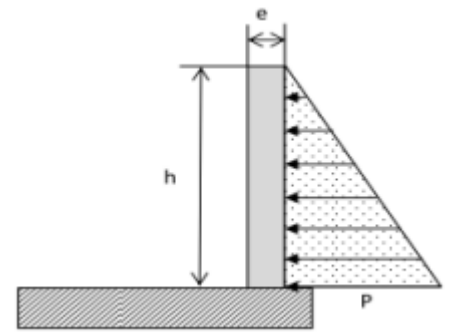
Poussée des terres sur les voiles périphériques.
